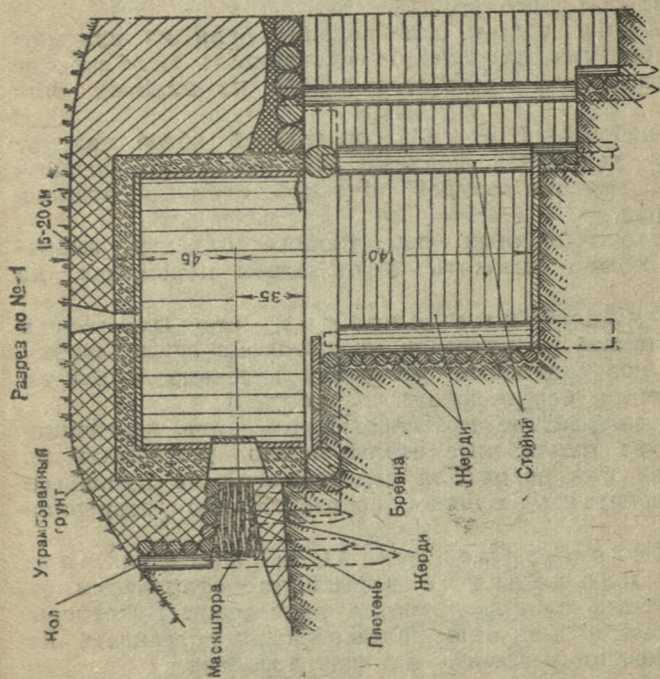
Усиление противоскользящего железобетонного колапа утрамбованным грунтом
